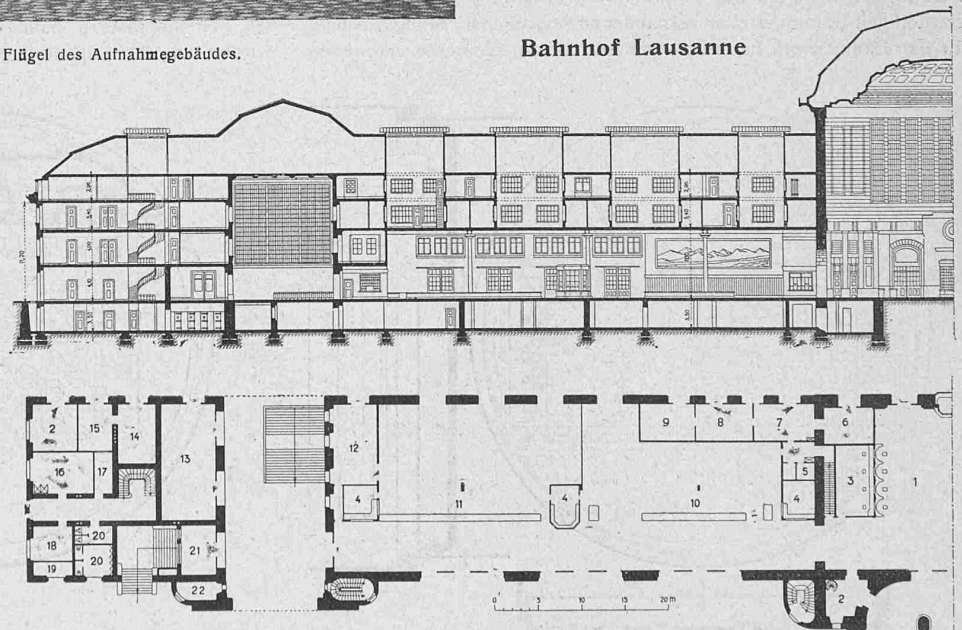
und 4. Grundriss und Längsschnitt der östlichen Gebäudehälfte. — 1:800. — (Legende S. 177.)
